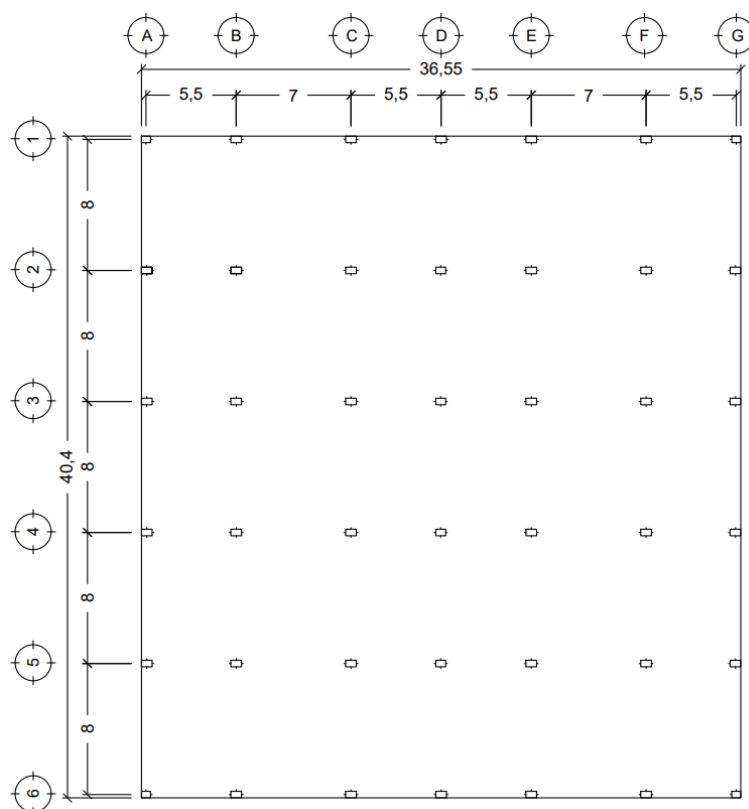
Vista en planta del edificio de rectorado de la ULEAM.
